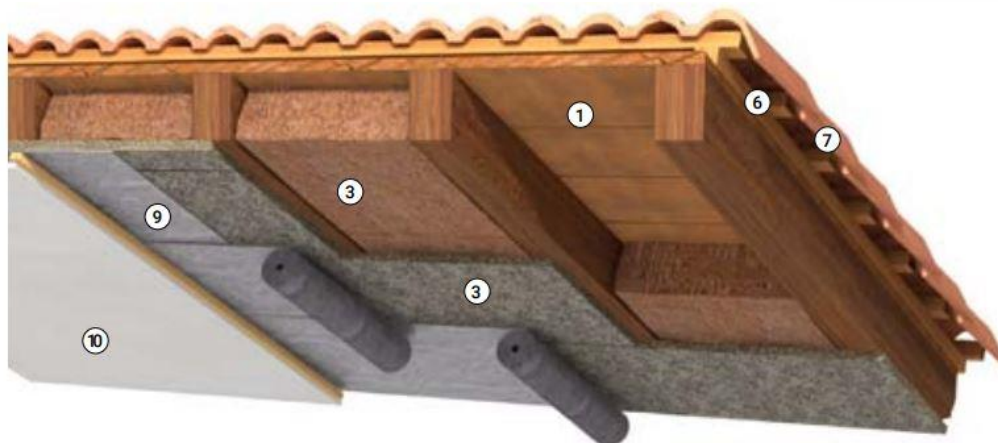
f – “spaccato” assonometrico e schematizzazione dell'applicazione dell'isolante
